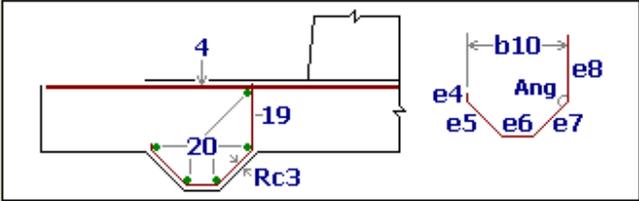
Caja de Corte Lateral Zapata con refuerzo adicional para Espolón 2
